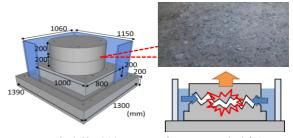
試験体寸法とひび割れ面と試験概要図
